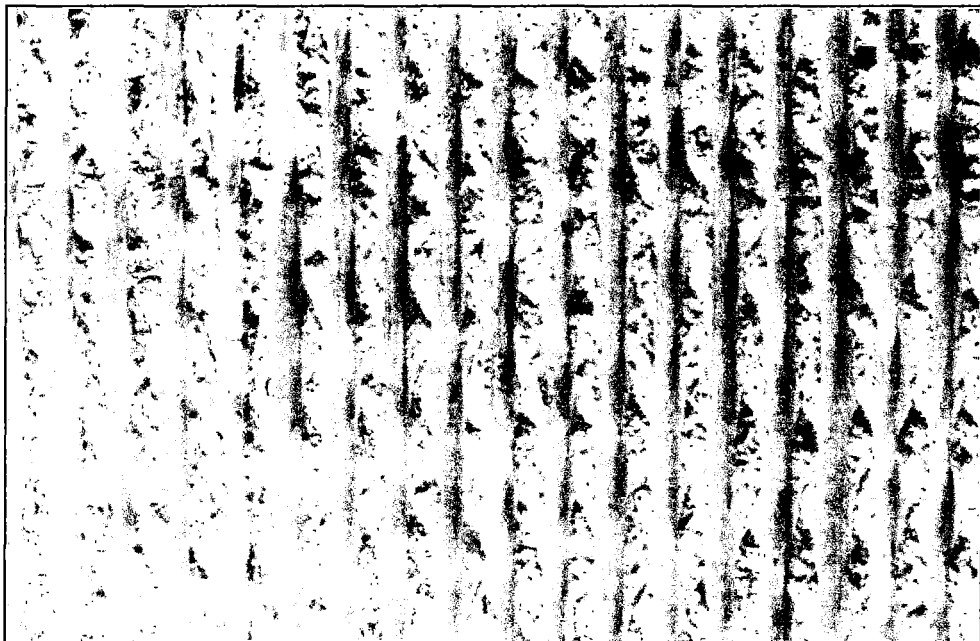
Vista del acabado tipo "bronco" fracturado.
